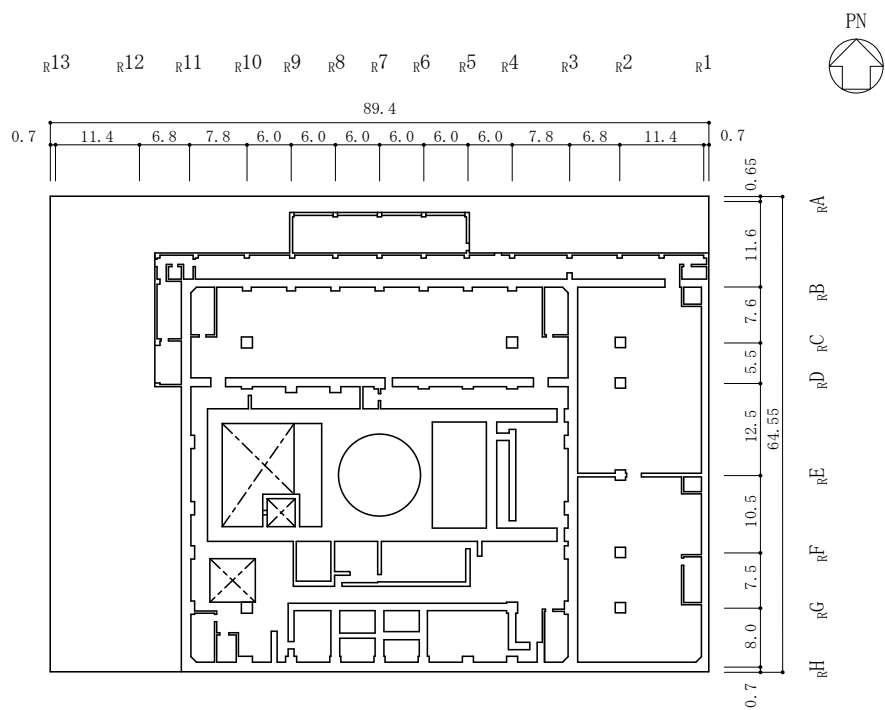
(4) 原子炉建物の概略平面図 (EL 23.8m)
